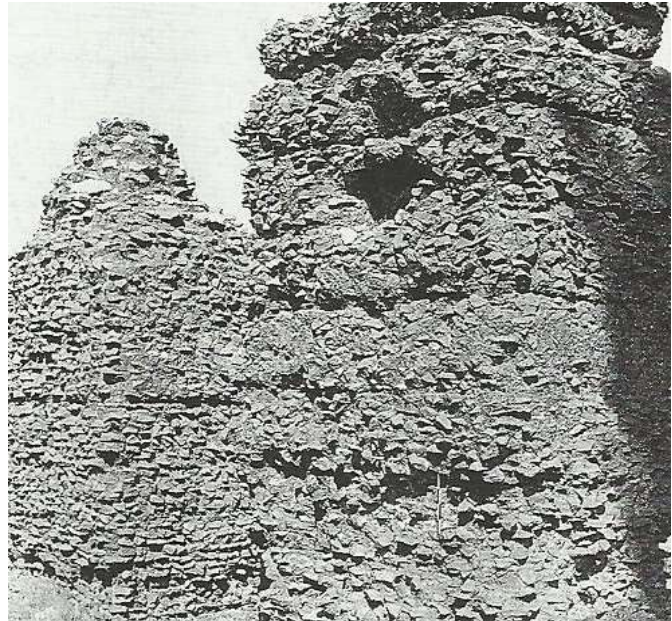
Macizo de opus caementicium realizado sin apisonar en dos mausoleos de la Vía Appia, donde los paramentos exteriores o modo de encofrado permanente han desaparecido. (Imagen171 de JPA (2002:81)).
